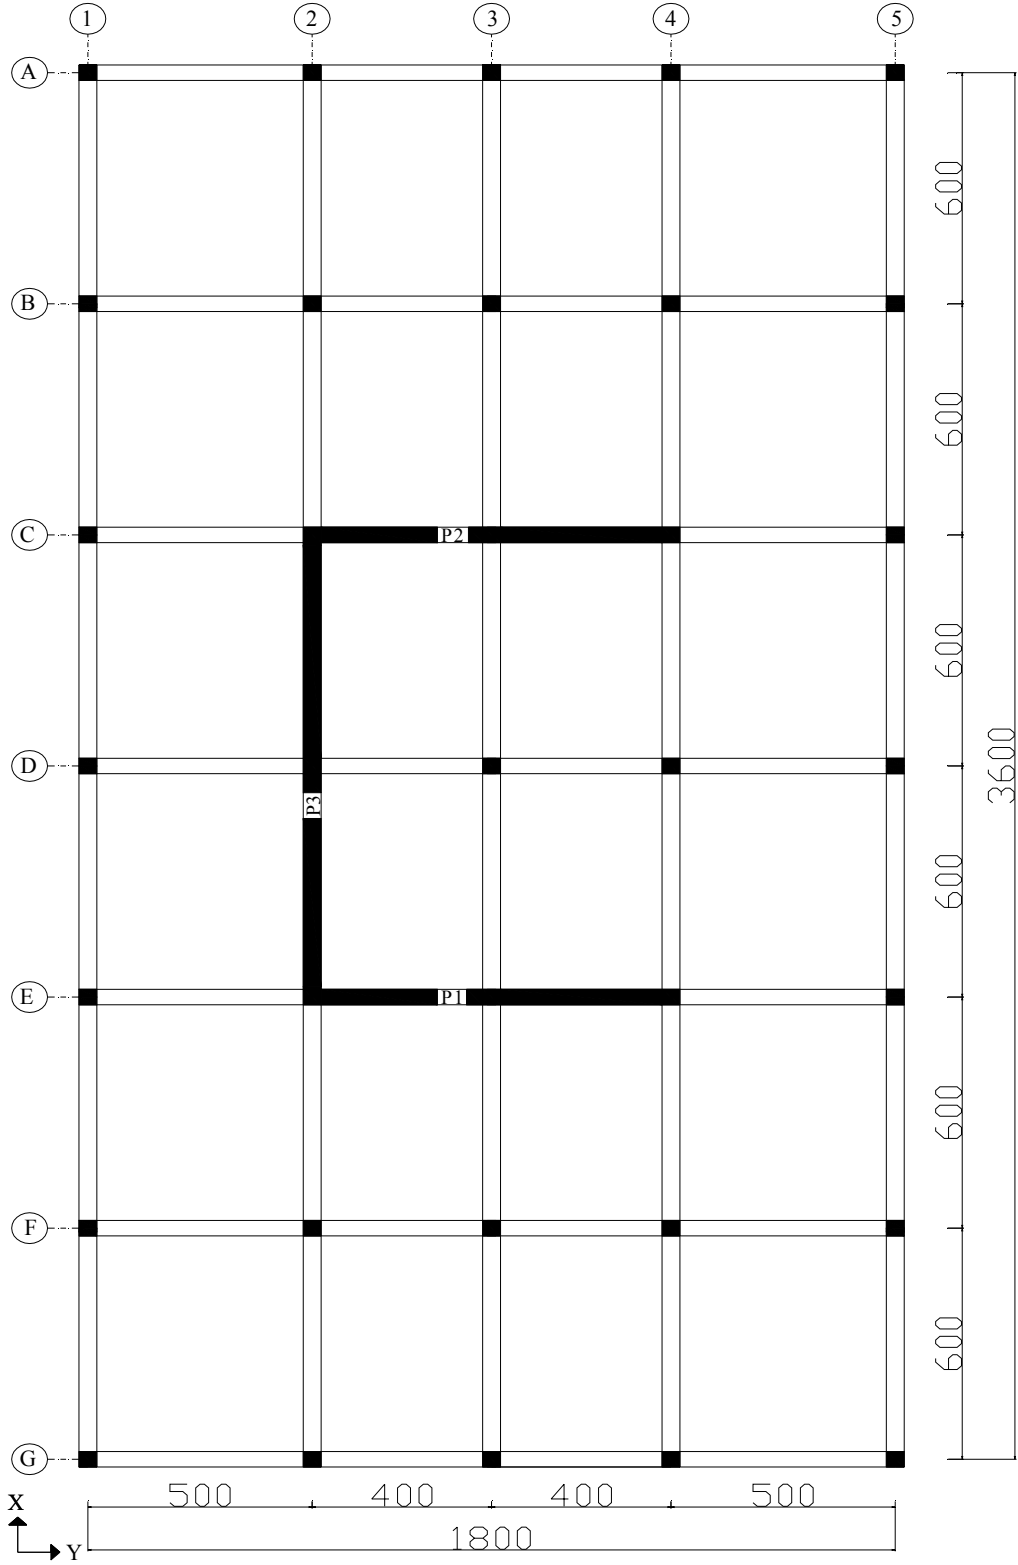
Örnek 5.16'nın kat kalıp planı
